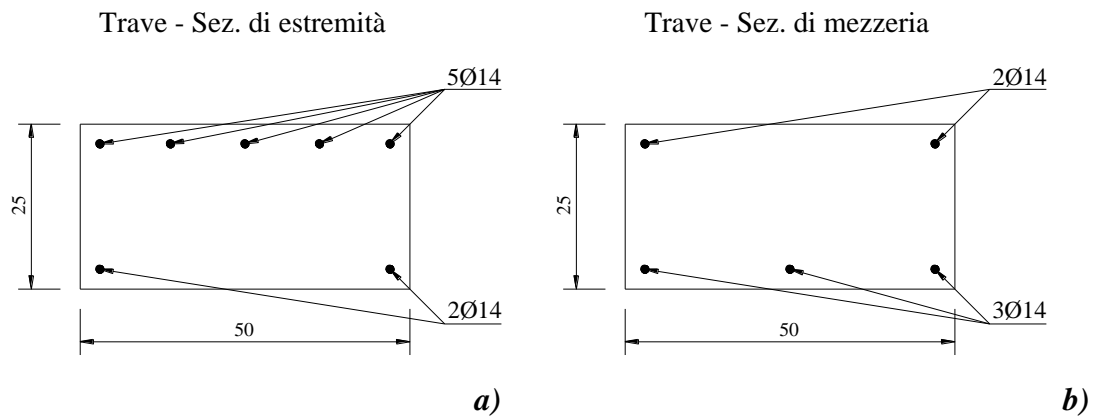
Sezioni delle travi: a) sezione all'estremità, b) sezione di mezzeria.
